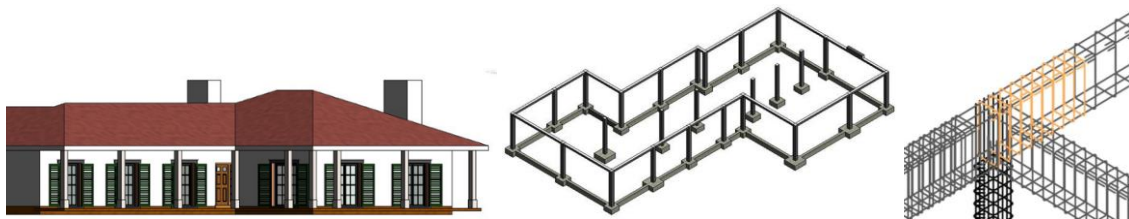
Geração das componentes de arquitectura e de estruturas e pormenorização de armaduras
